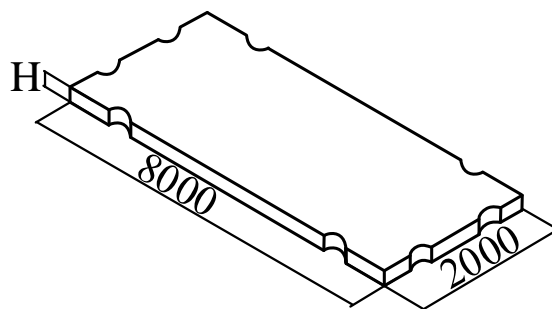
Плиты для аэродромных покрытий и покрытия дорог
